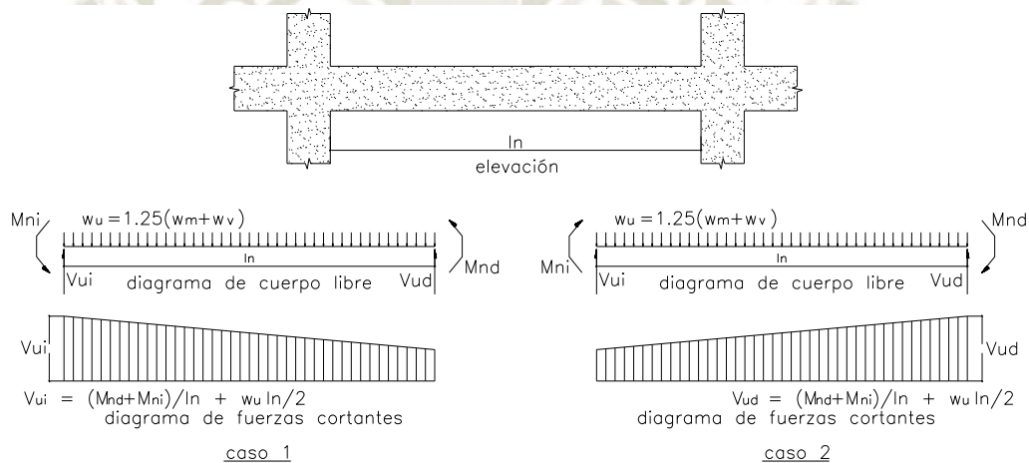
Cortante última para vigas (Figura 21.4.3a de norma E.060 del R.N.E.)
